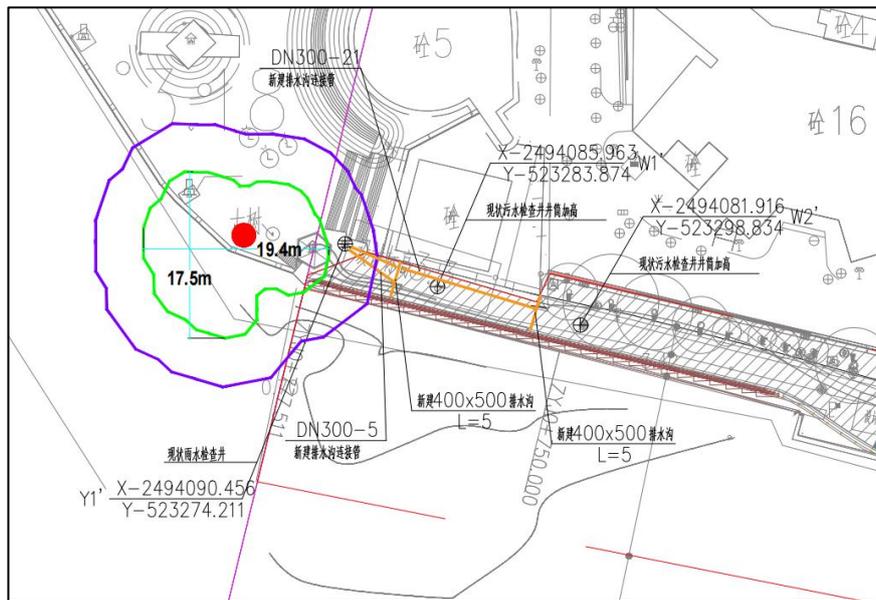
线性截流沟埋设位置平面图（橙色线条）
